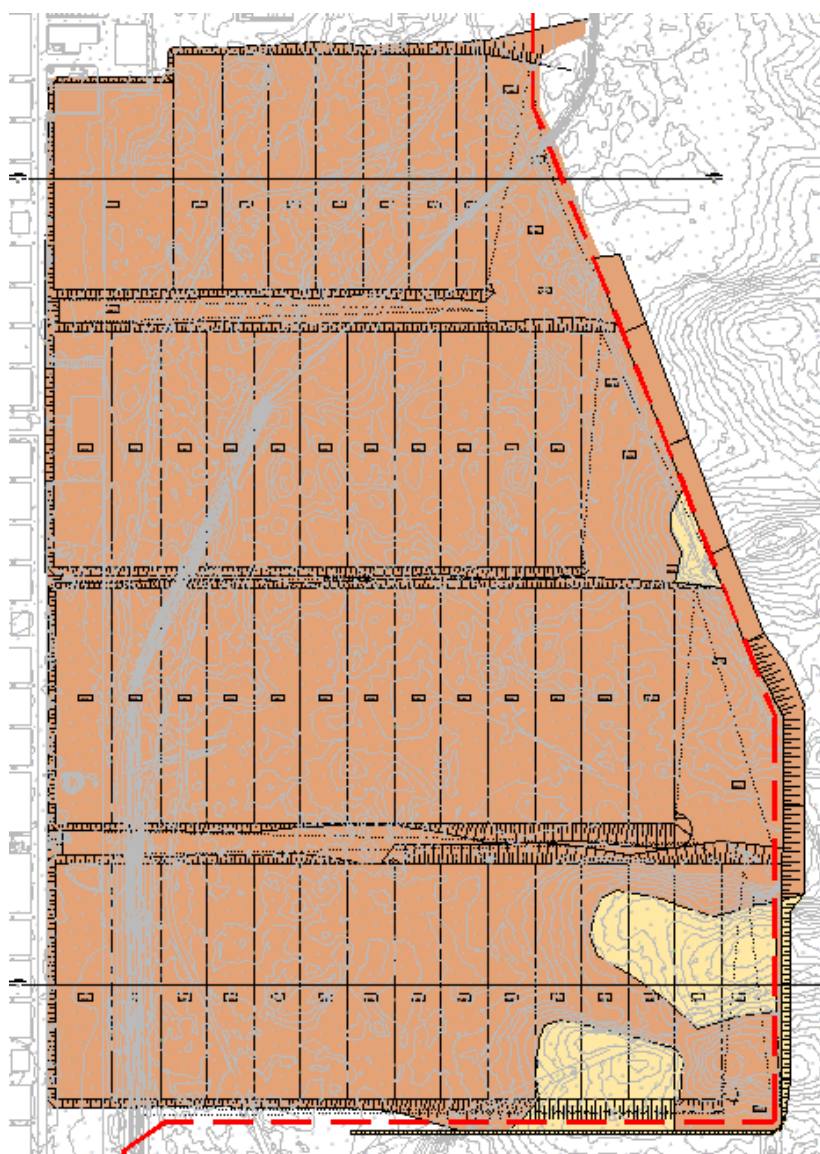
Zonas de aterro (a castanho) e zonas de escavação (a amarelo)
